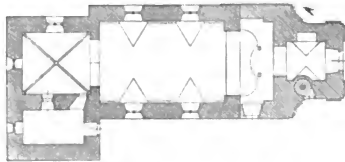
Pitschin. Grundriss. der Kirche.
